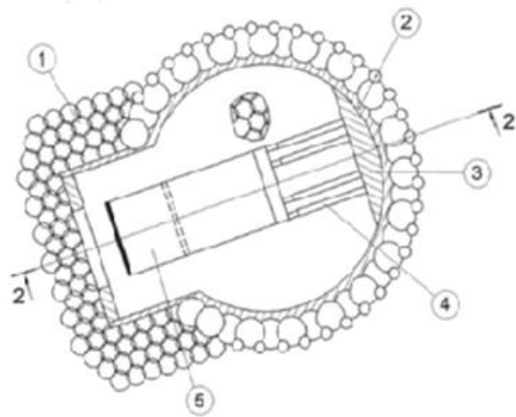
Влаштування стартового котловану (стовбур, колодязь): 1 – закріплення ґрунту ґрунтоцементними колонами; 2 – огороження шахтного стовбура (ґрунтоцементна колона + бетона стіна); 3 – упорна плита; 4 – домкратна станція; 5 – мікрощит
